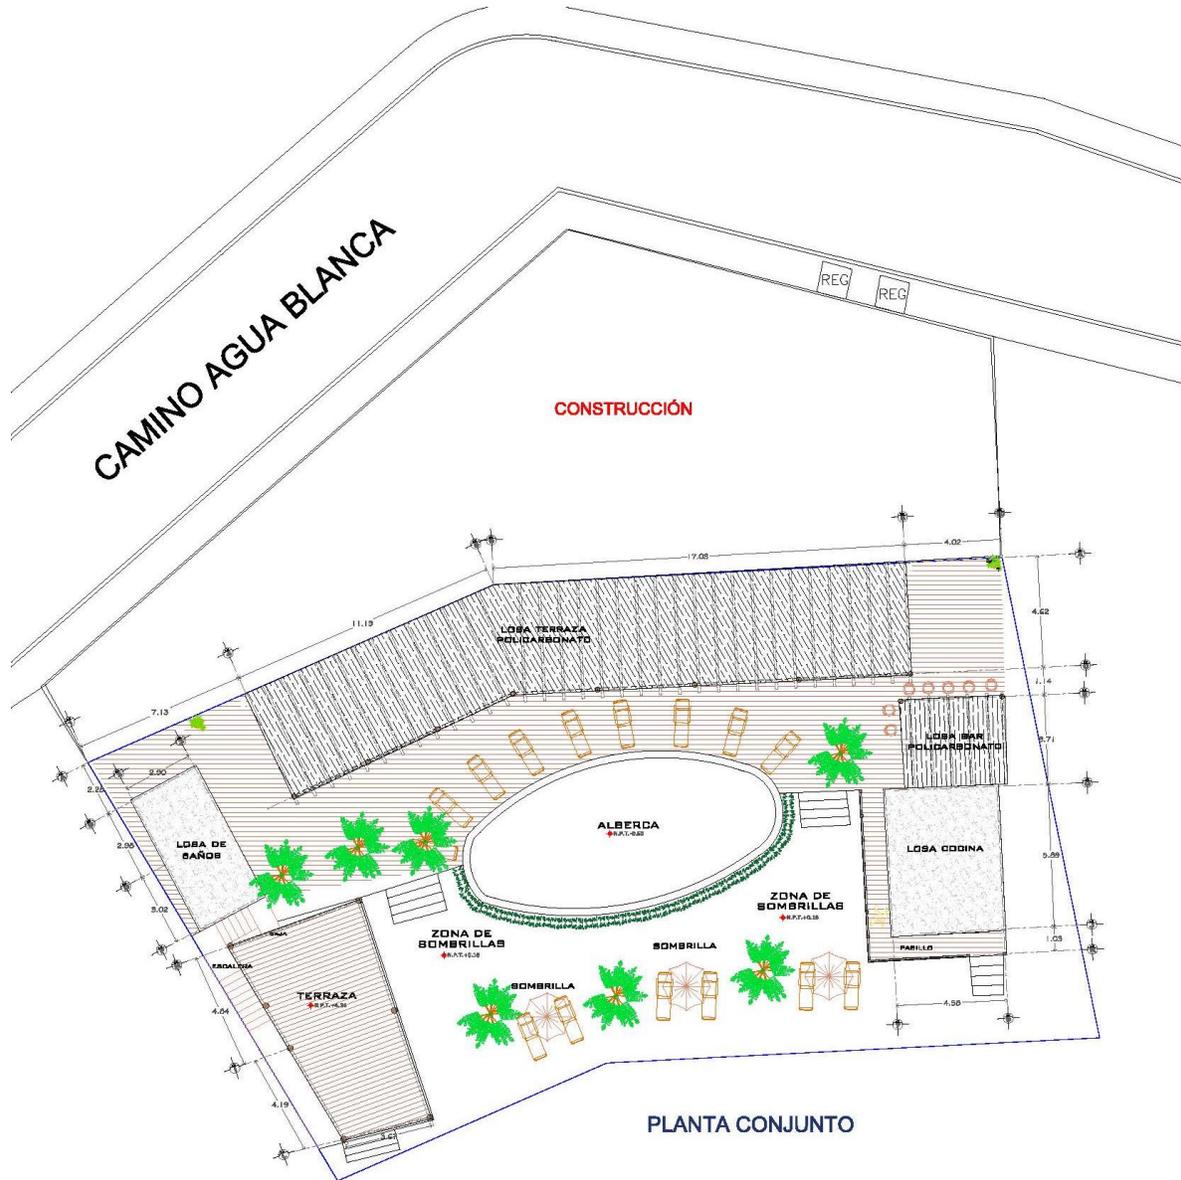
Plano arquitectónico de las obras a construir, planta de conjunto.
